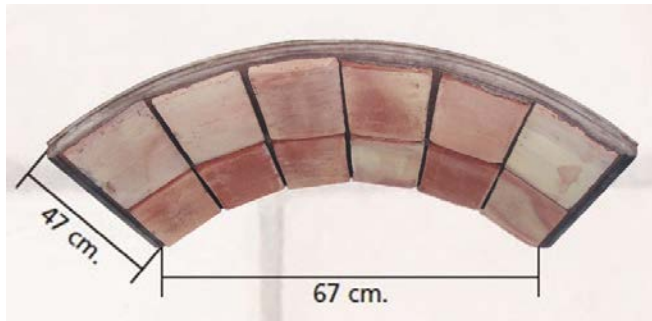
Hiladas prefabricadas de ladrillo. Nicaragua.
